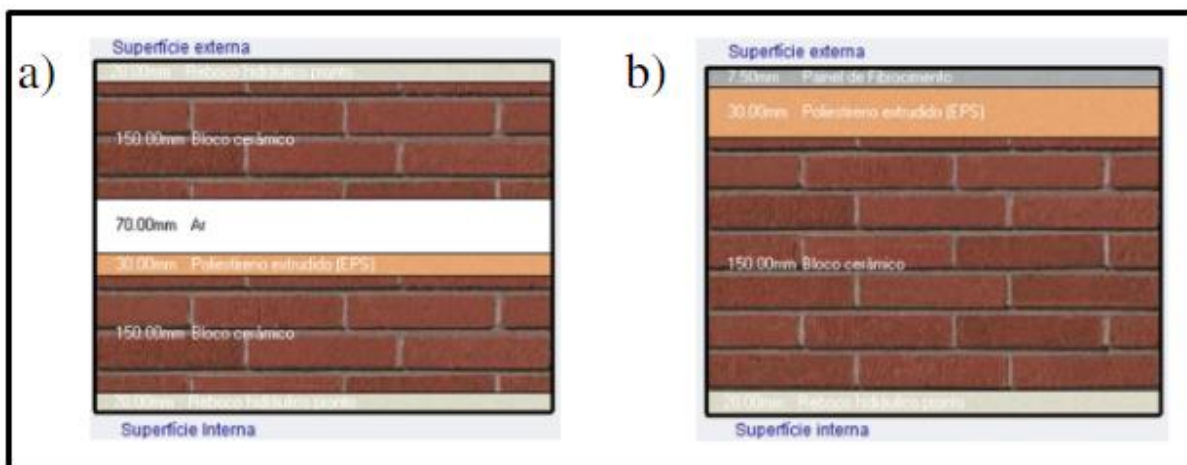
Pormenores construtivos das paredes externas: a) Parede externa tipo E1; b) Parede externa tipo E2
